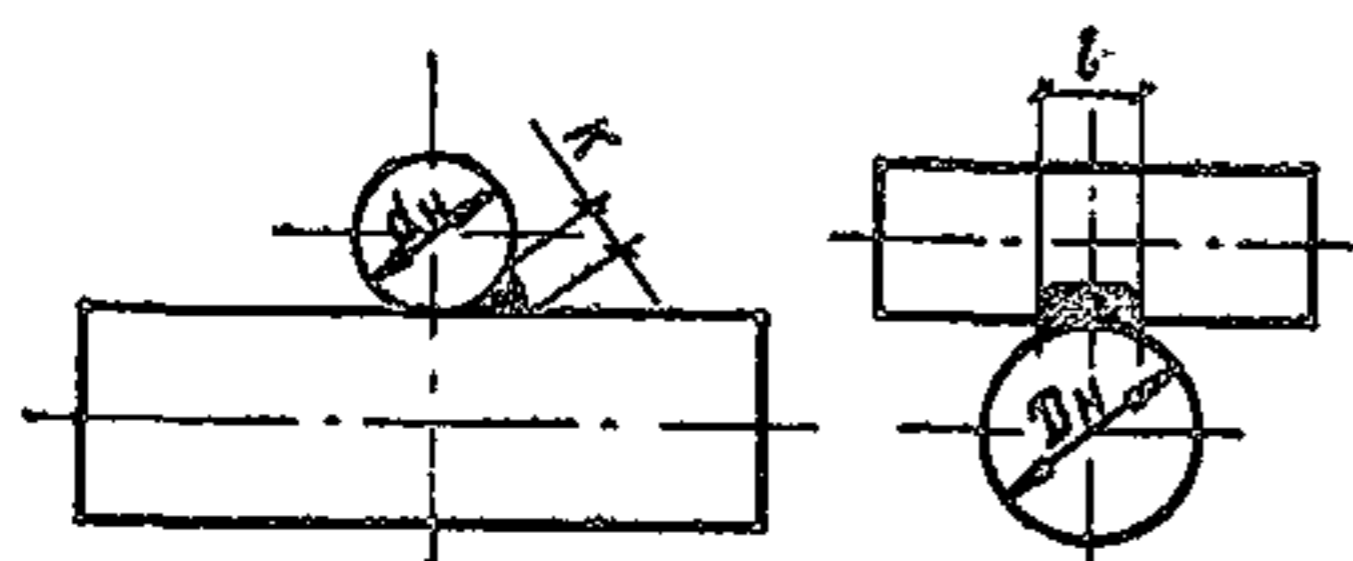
Конструктивные элементы крестовых соединений стержней, выполненных дуговой сваркой с принудительным формированием с горизонтальным (I) и вертикальным (II, III) положением сварных швов
